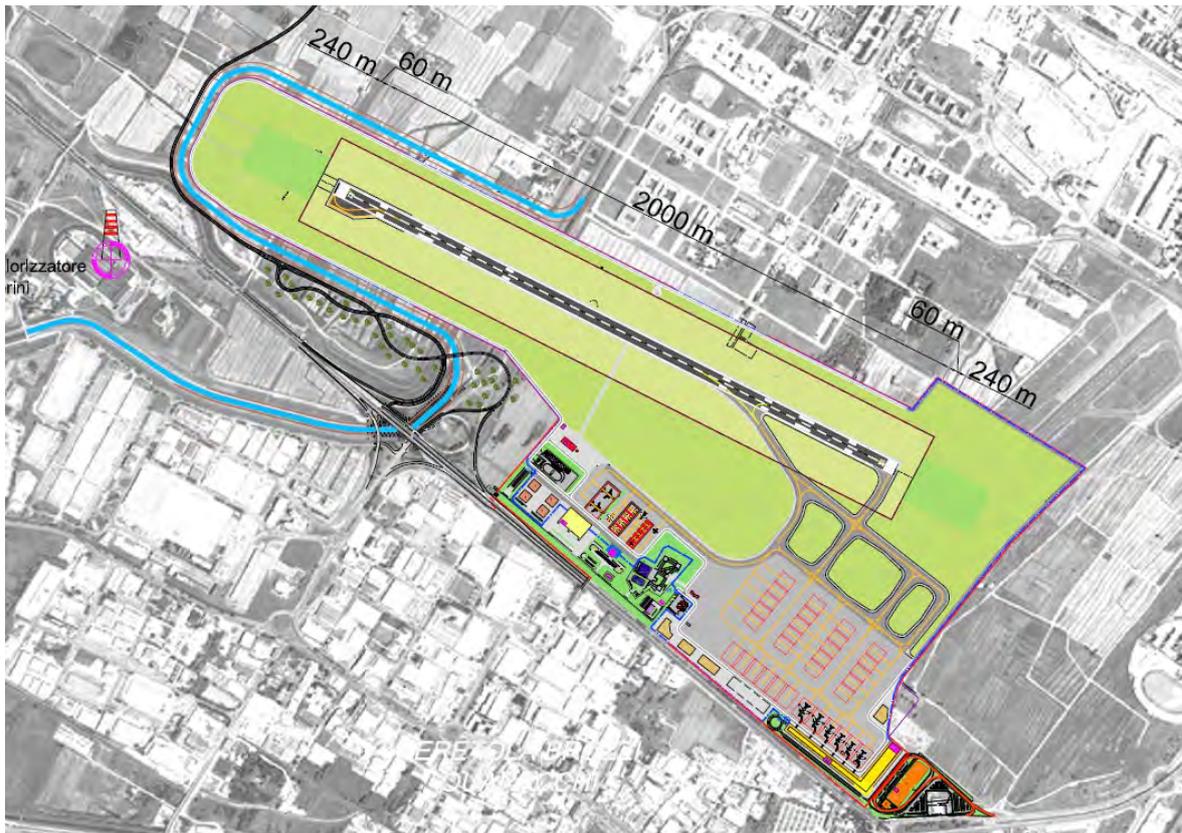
Rappresentazione dell'alternativa progettuale 1 – pista 09-27
